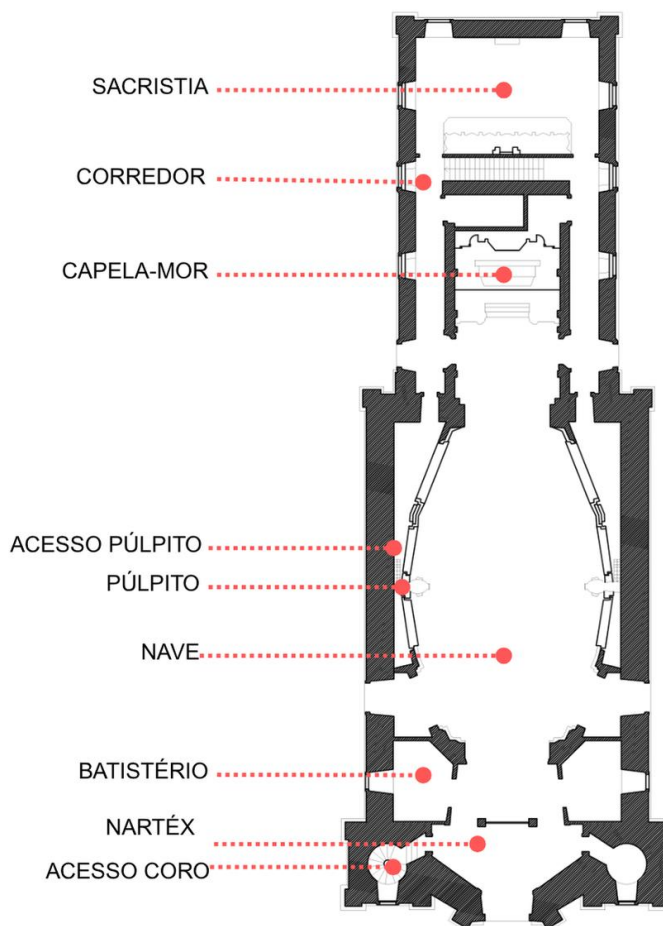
Planta da Matriz do Pilar - Ouro Preto (MG)
